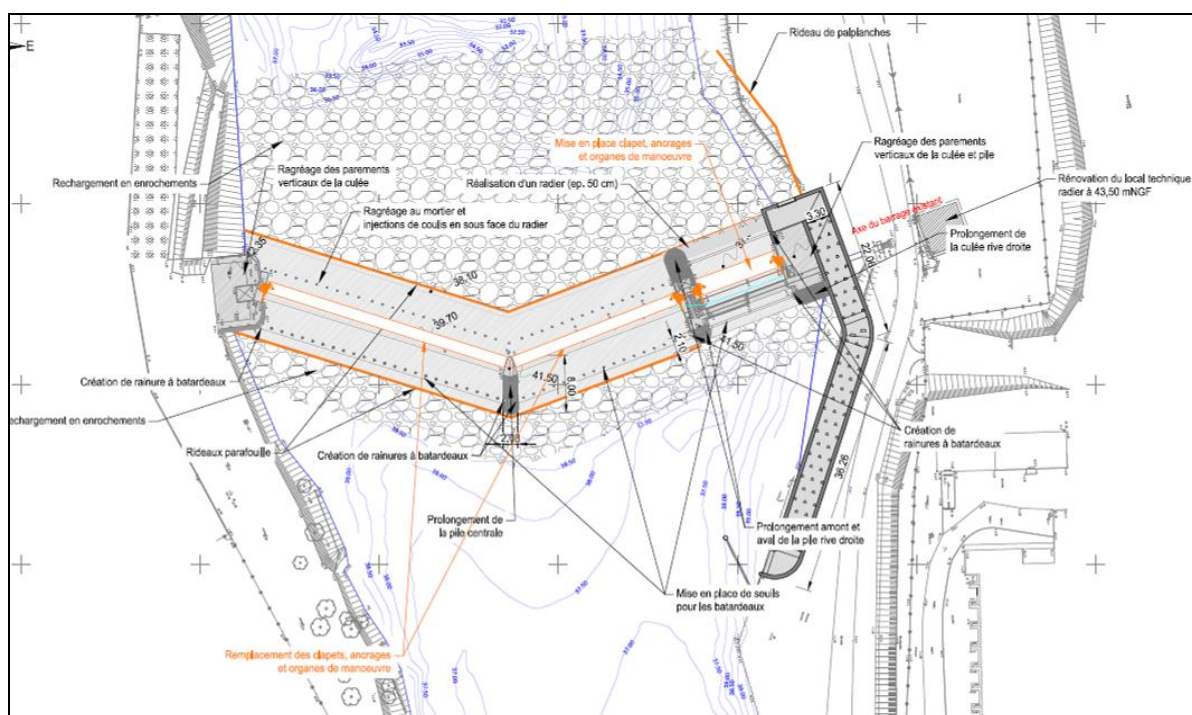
Plan d'aménagement du scénario 2 (Avec rampe à macro-rugosités)
